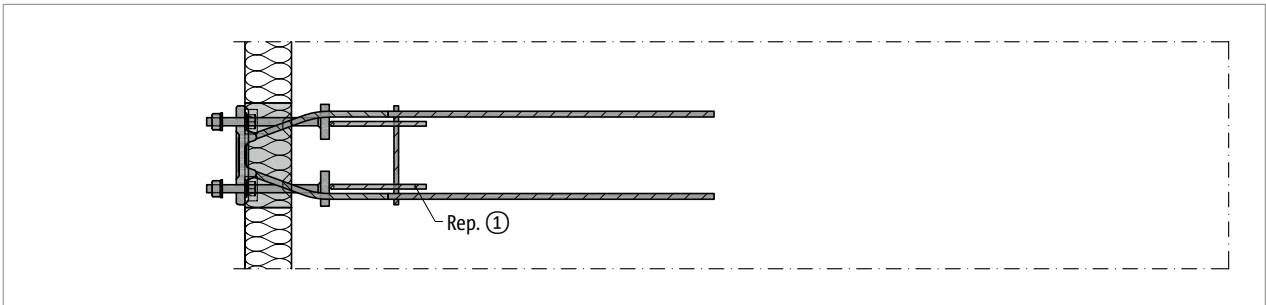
Schöck Isokorb® T type SQ : armatures à prévoir par le client, vue en plan
